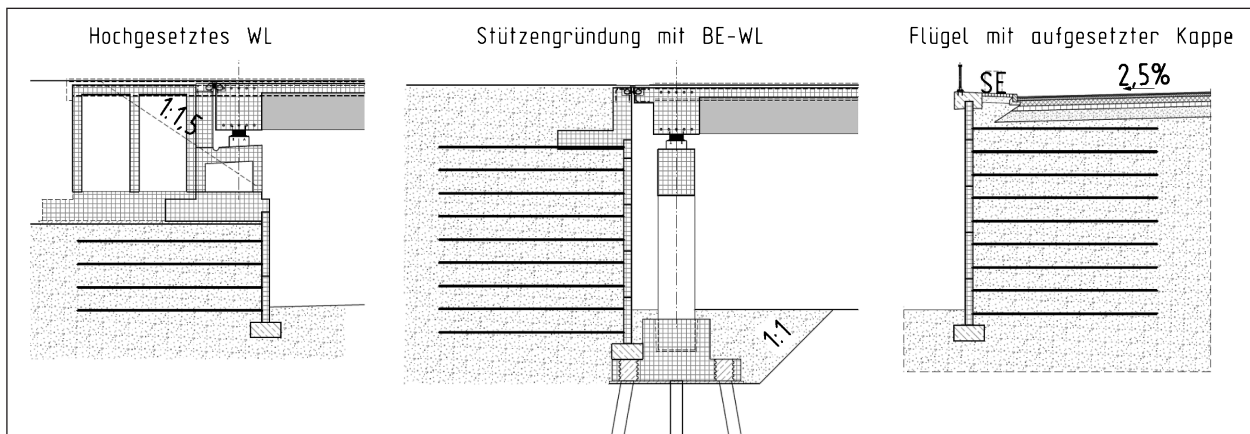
Widerlager aus bewehrter Erde (links), Auflagerträgergründung über Stützenkonstruktion (Mitte) und Flügelwände aus bewehrter Erde (rechts)
